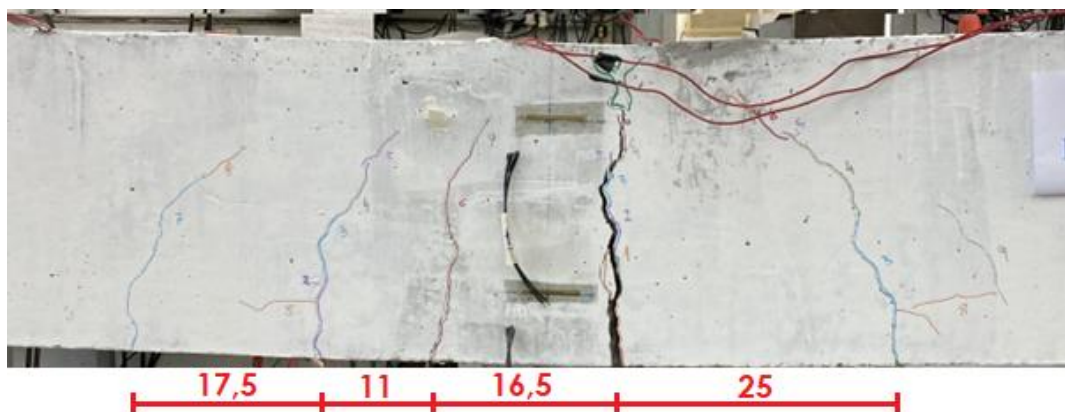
Espaçamento entre fissuras na viga 1 (espaçamento em centímetros)
